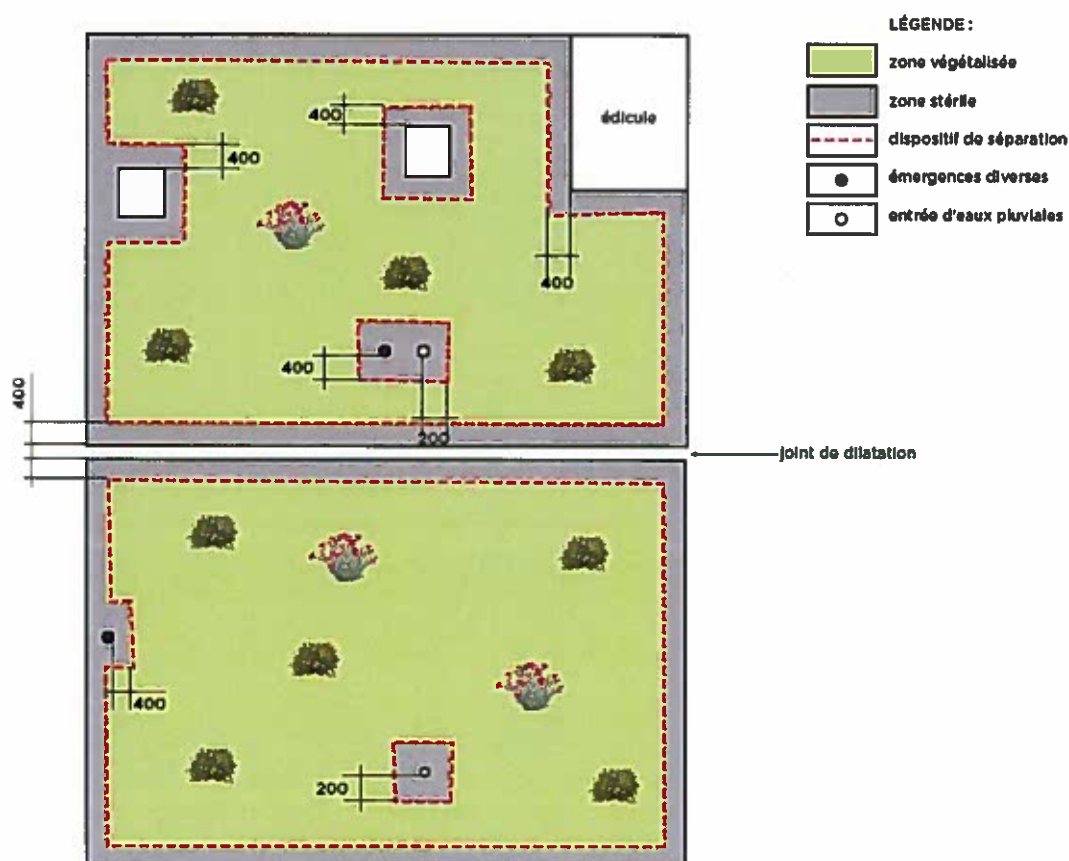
Zones stériles des toitures terrasses végétalisées inaccessibles sauf pour l'entretien
